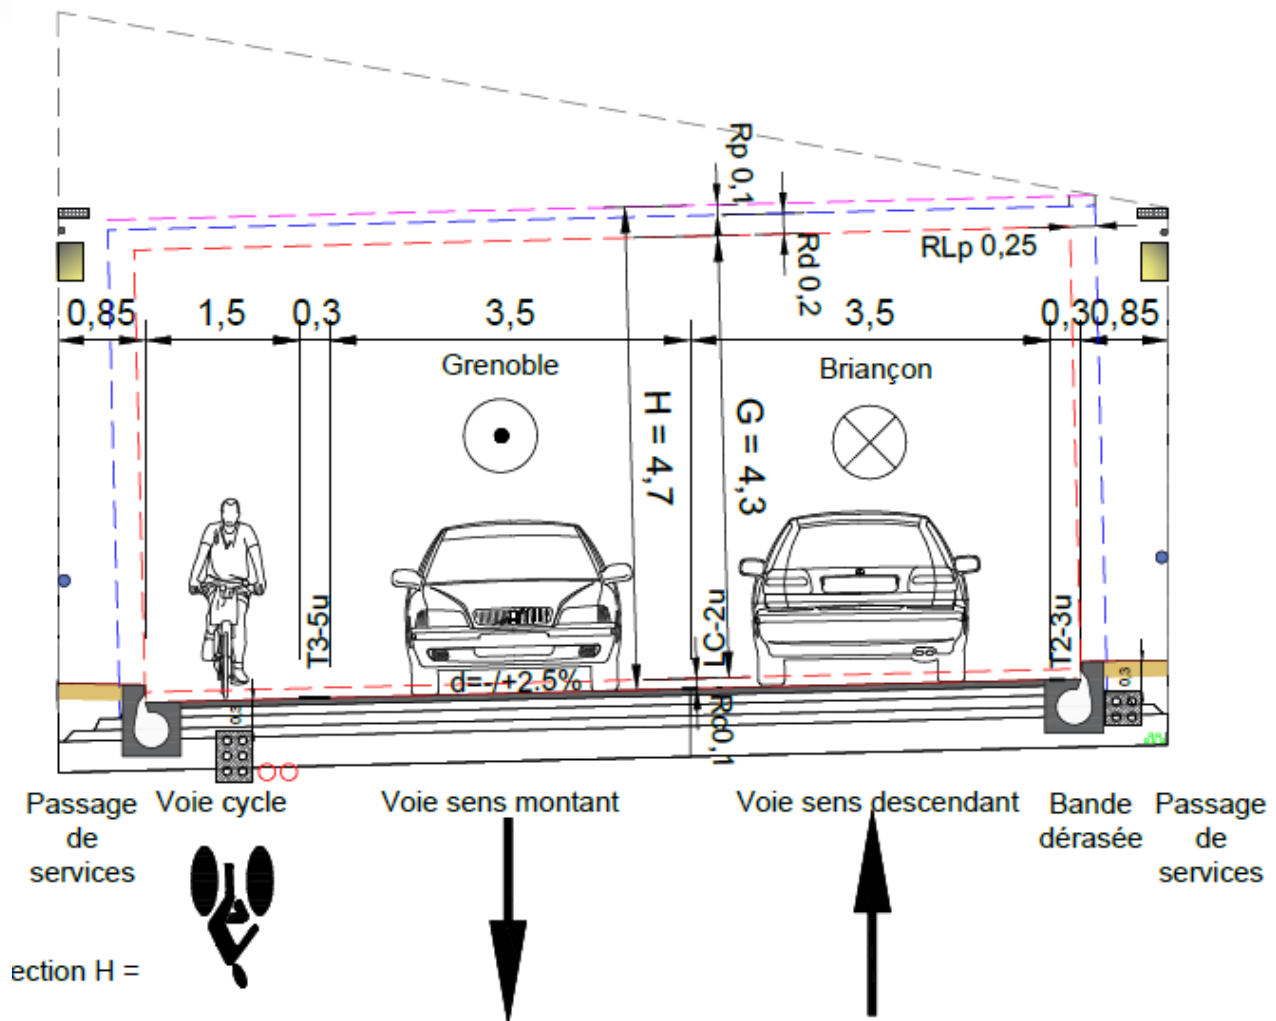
Coupe fonctionnelle avec caniveaux TMD
